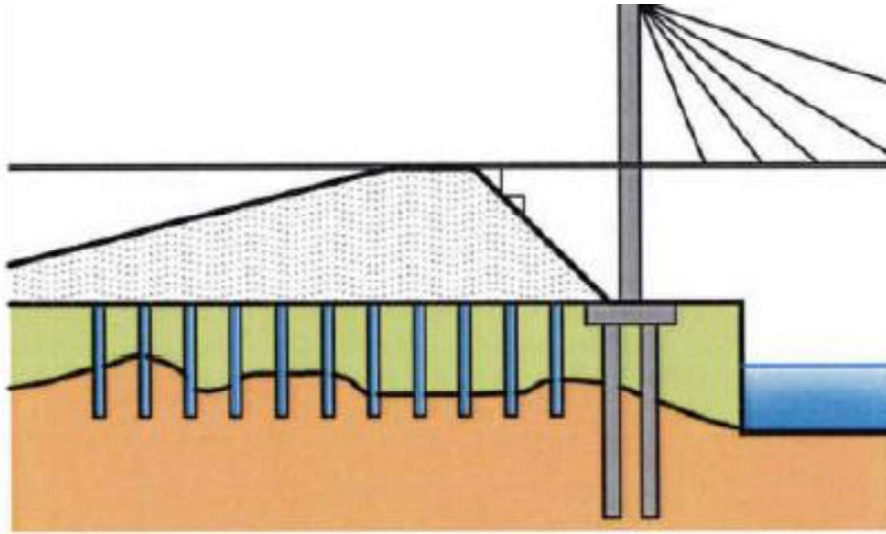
Terraplén utilizado para acceder a un puente. Fuente (Simon, 2011).
